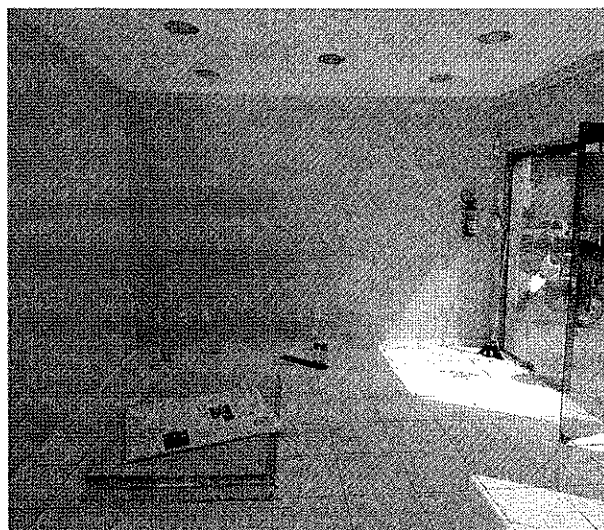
Sala do pavimento térreo com rebaixamento em gesso e fachada com vidro de segurança.
